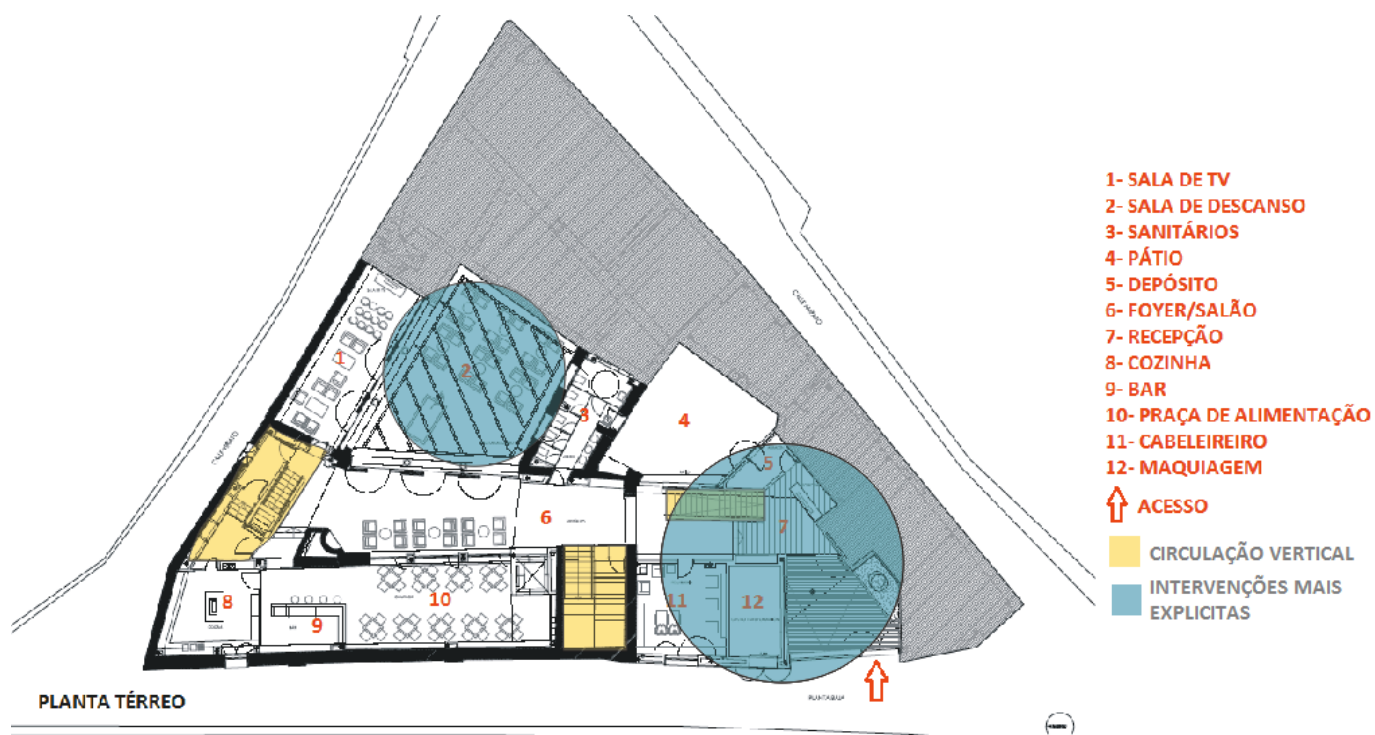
PLANTA TÉRREA DA INTERVENÇÃO.
